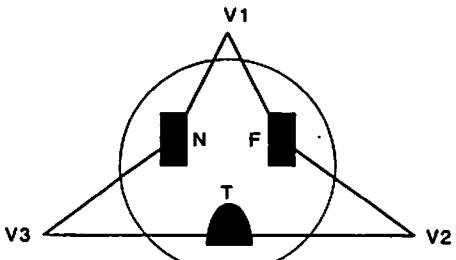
Instalação correta da ligação FASE, NEUTRO e TERRA.
